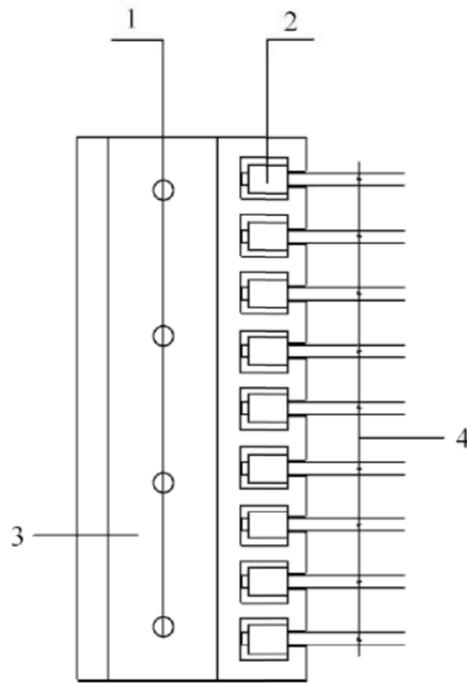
采用固定结紧固钢丝绳的端头锚固构造
